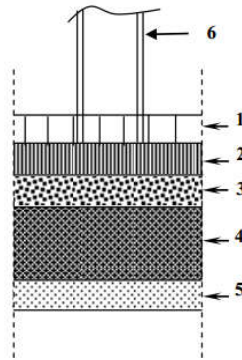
Coupe transversale du plancher terrasse inaccessible.
